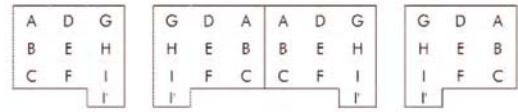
Planta de conjunto con cuatro viviendas. En los espacios libres se ubicaron a las escaleras.
